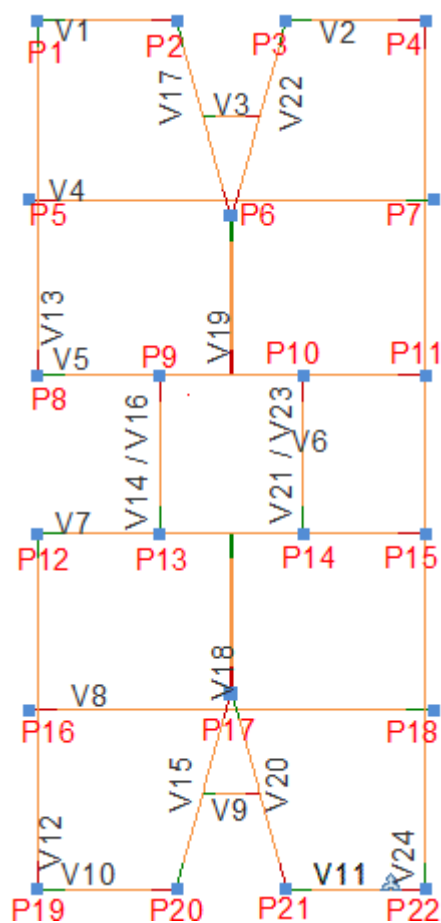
Modelo analítico do pavimento tipo com a laje oculta da vista.
